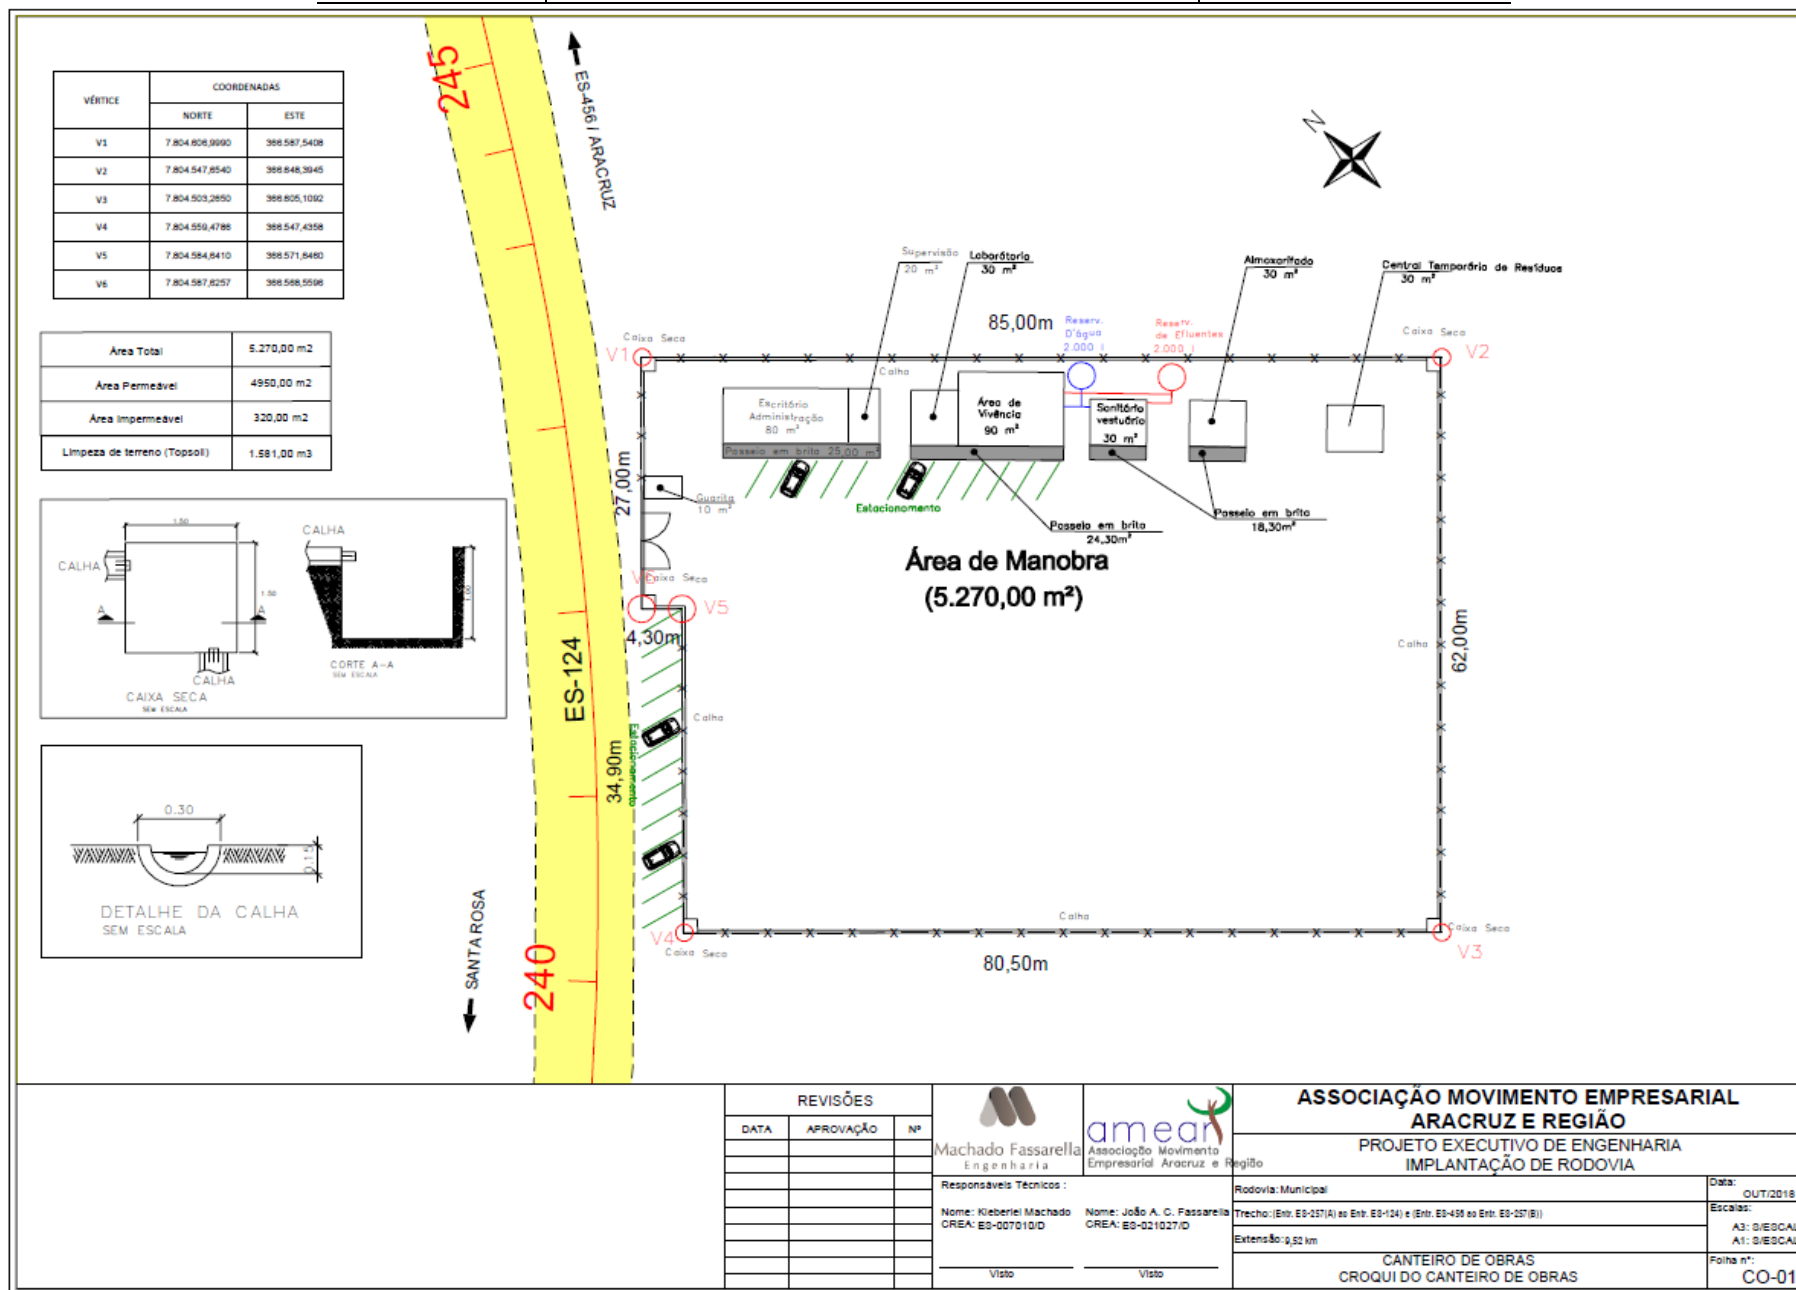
Desenho esquemático demonstrando as estruturas presentes no canteiro de obras do trecho Sul e sua disposição.
